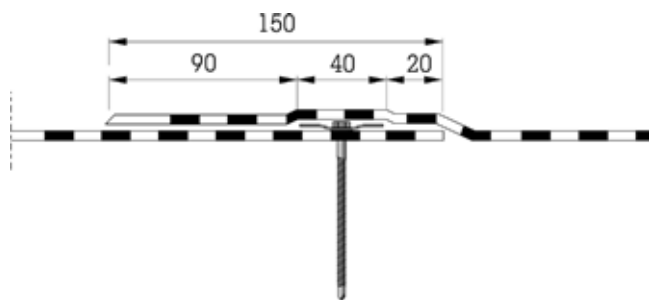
Verbinding in dwarsrichting bij mechanische bevestiging
